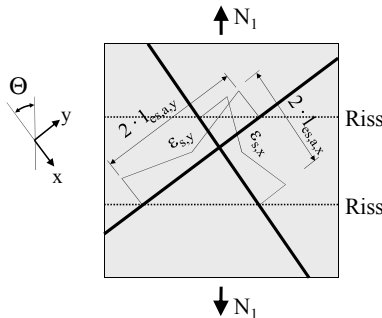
Einleitungslänge im abgeschlossenen Rissbild
